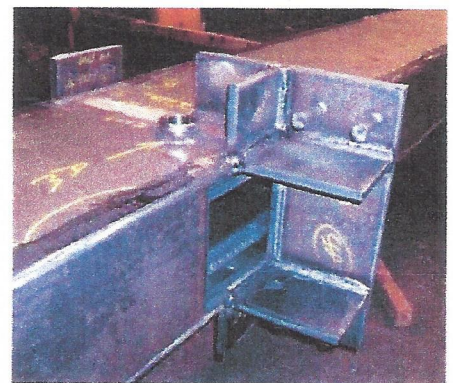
Auflagerkranz für Stahlbetondecken (© Werksfoto Vollack Bautechnik®)
